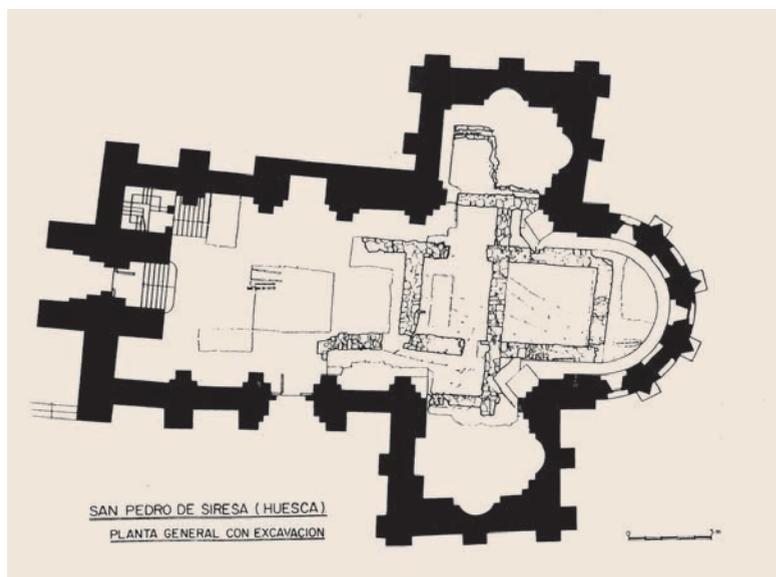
Planta de San Pedro de Siresa con excavación arqueológica (según R. Puertas Tricas)
